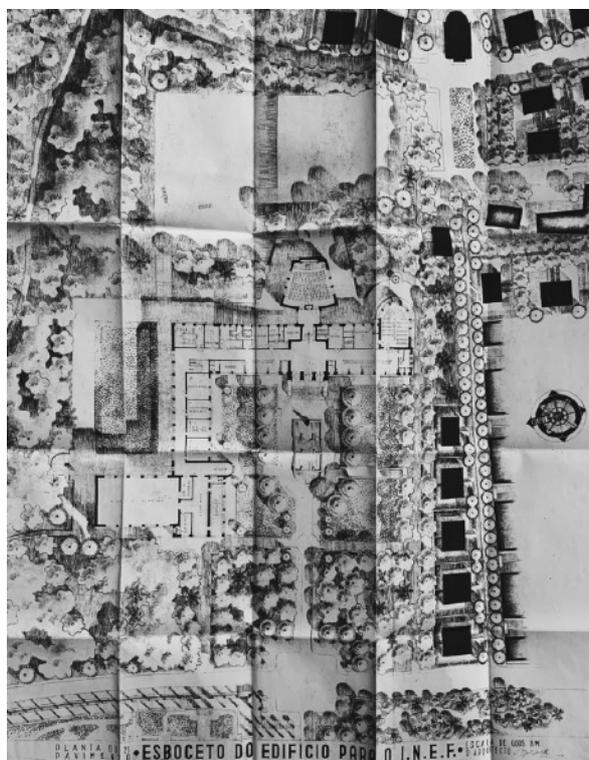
Planta do piso 0 - Anteprojeto (1943)
